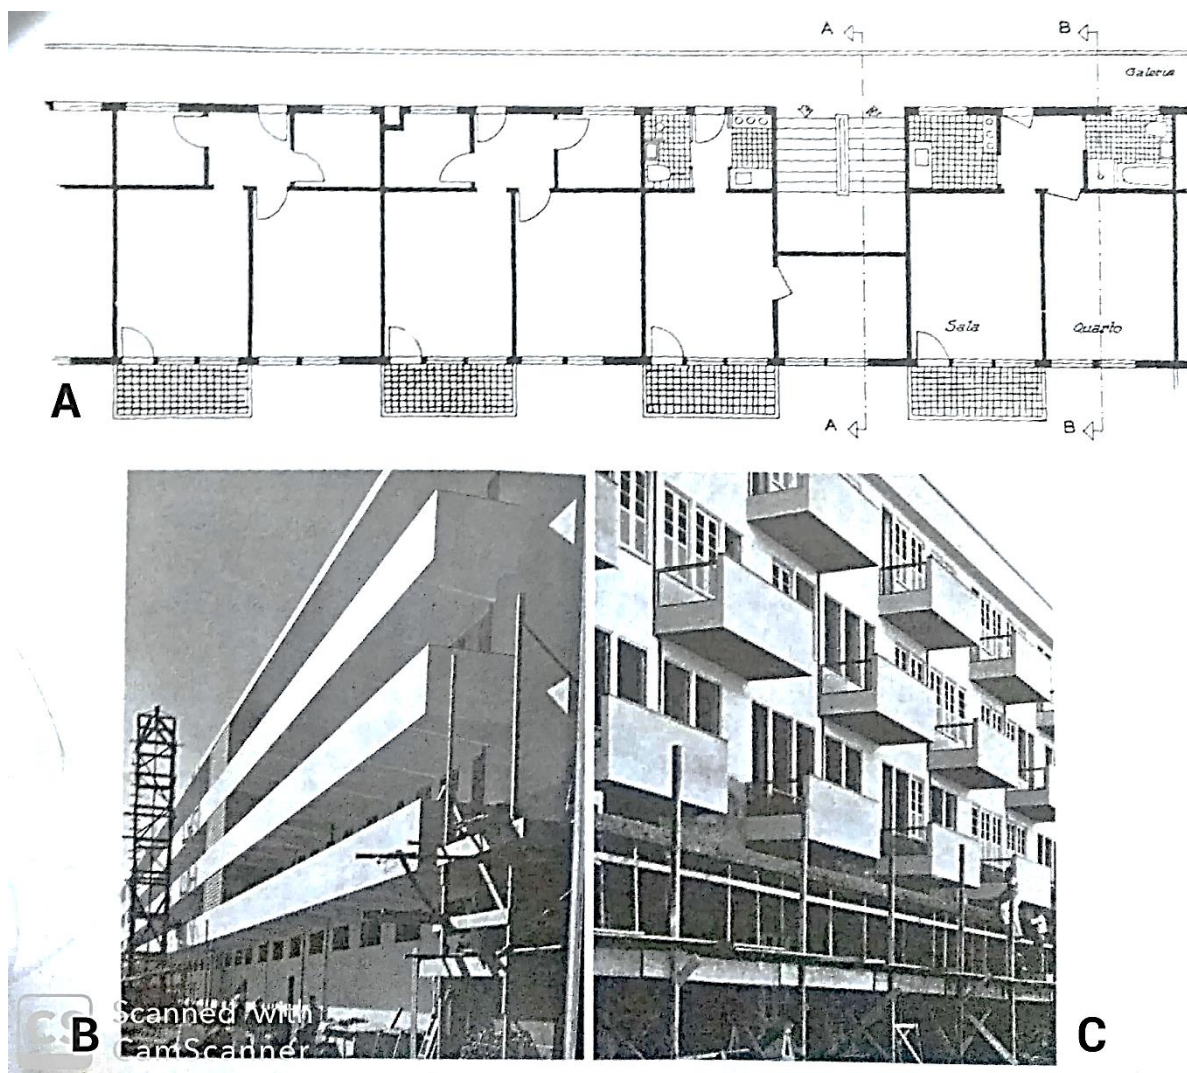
Conjunto Residencial Realengo, no Rio de Janeiro. (A): pavimento-tipo, (B): fachada posterior do edifício e (C): fachada principal do edifício. Fonte: Bonduki, 2011, p.181.
